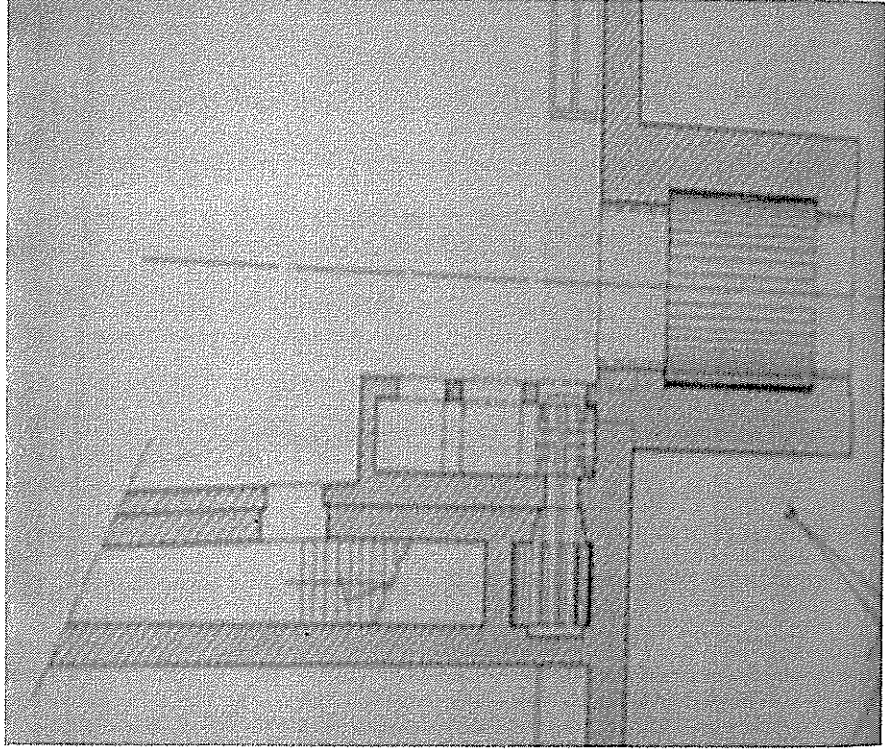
مسقط أفقي لباب الهري الرئيس، نقلاً عن Marianne Barrucand, Architecture
